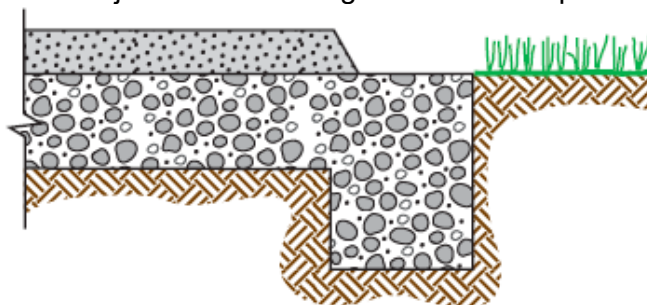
Zanja rellena de roca bajo el pavimento. [43]
